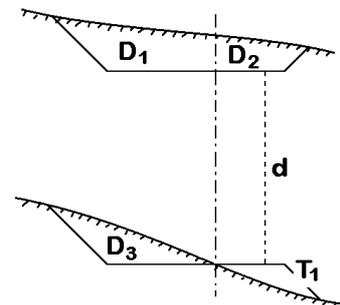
Un perfil en desmonte y otro a media ladera
